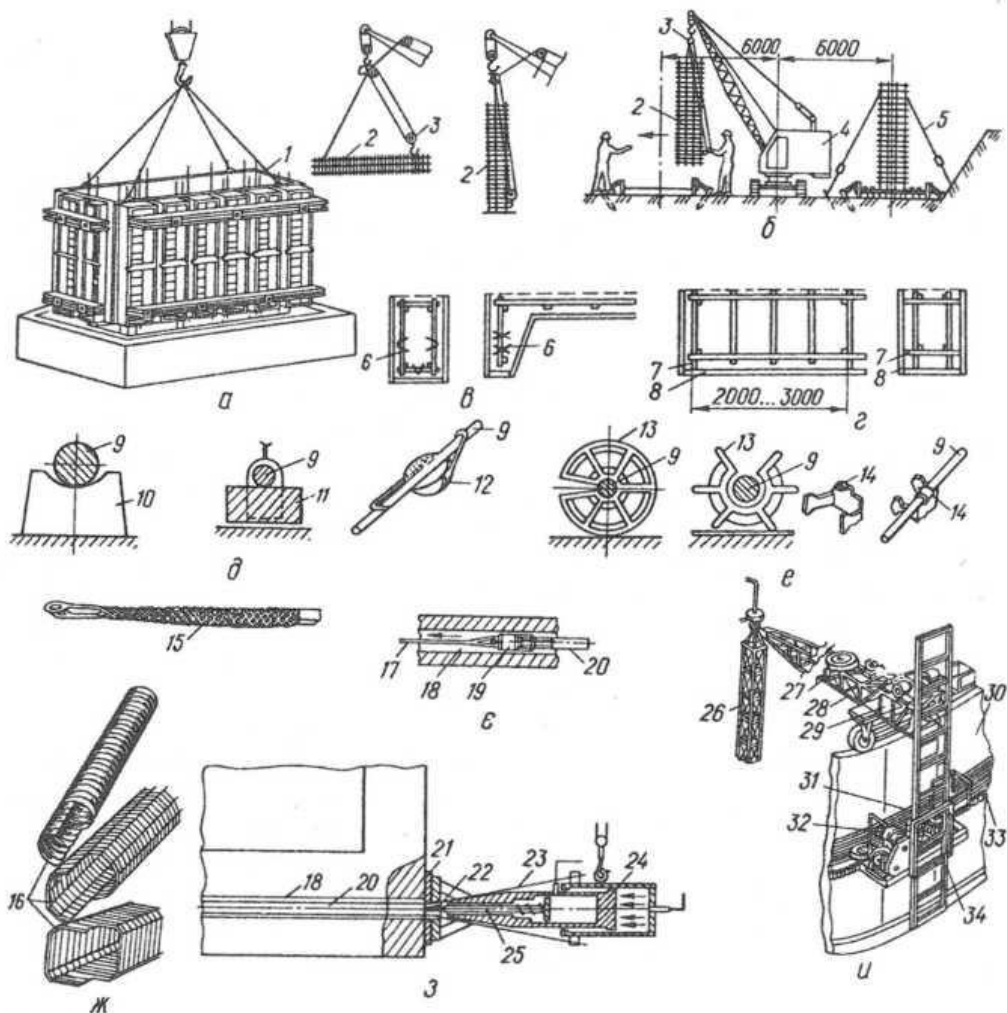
14. Монтаж арматури: *a* — монтаж арматурно-опалубного блока; *б* — монтаж арматурного блока підколонника; *в* — улаштування захисного шару за допомогою упорів; *г* — те саме, із застосуванням подовжених стрижнів; *д* — те саме, із застосуванням бетонних підкладок; *е* — те саме, із застосуванням пластмасових і металевих фіксаторів; *є* — схема затягування напруженої арматури в канал; *ж* - каналоутворювачі; *з* - схема розміщення домкрата подвійної дії для натягування арматури; *и* - машина для навивання напруженої арматури; *1* - арматурно-опалубний блок; *2* - арматурний блок; *3* - напівавтоматичні стропи; *4* - стріловий кран; *5* - розтяжка; *6* - упори з арматурного дроту; *7* - подовжені арматурні стрижні; *8* — опалубка; *9* - стрижень арматури; *10* - бетонна підкладка; *11* - те саме, із скруткою дроту; *12* - те саме, з пружинними скобами; *13* - пластмасові фіксатори; *14* - металеві штамповані підкладки; *15* - гумовий каналоутворювач із петлею для його витягування; *16* - рифлені каналоутворювачі із сталеві стрічки; *17* - трос; *18* - канал; *19* - човник; *20* - напружена арматура; *21* -плита; *22* - клиноподібна пробка; *23* - пучок дроту; *24* — циліндр з поршнем для натягування дротин пучка; *25* -те саме, для запресовування клиноподібної пробки; *26* — центральна опора; *27* — бухтотримач; *28* — стріла; *29* — верхній візок; *30*— стінова панель; *31* — намотувана напружена арматура; *32* — нижній візок; *33* — ланцюг; *34* —вертикальна рама машини
